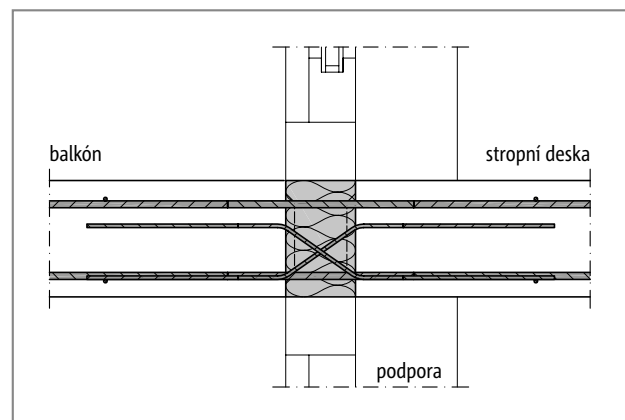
Schöck Isokorb® typ DXT, QXT: Křížem vyztužená deska; prvek Schöck Isokorb® ale působí pouze v jednom směru
